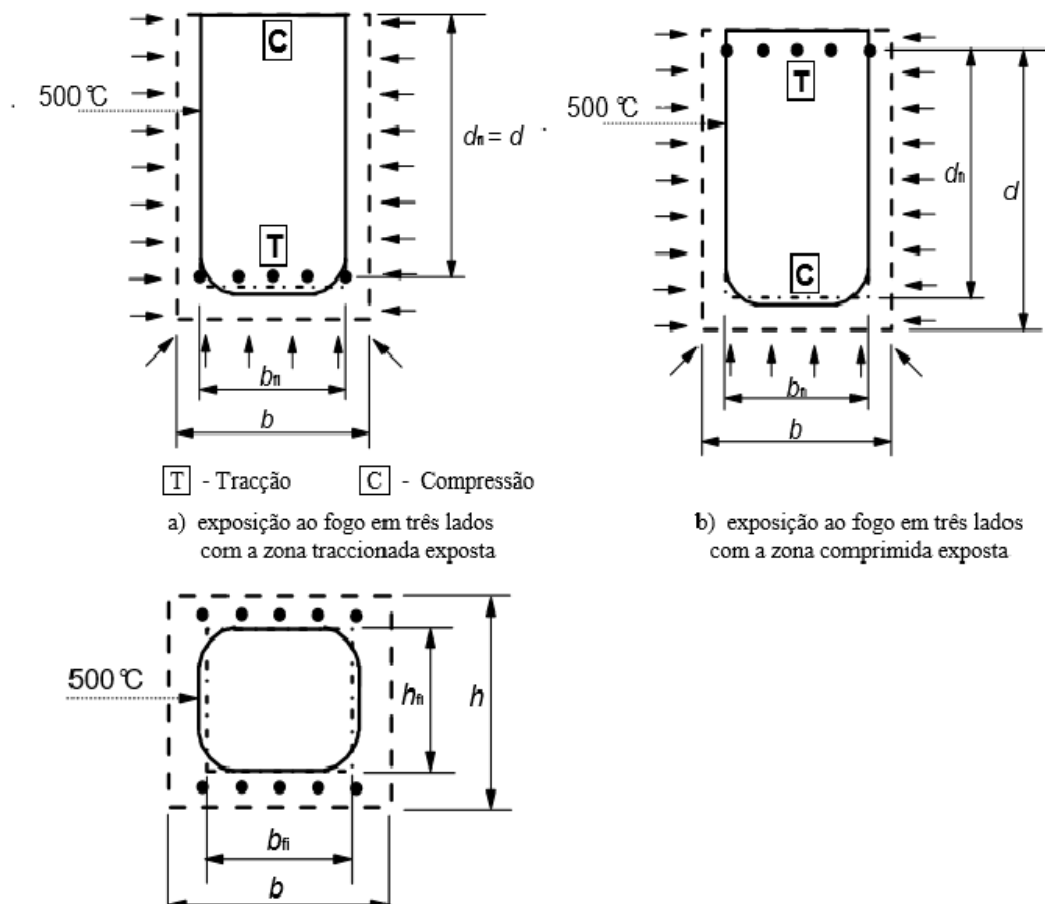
Secção transversal reduzida de vigas ou pilares em betão armado (EN 1992-1-2)
